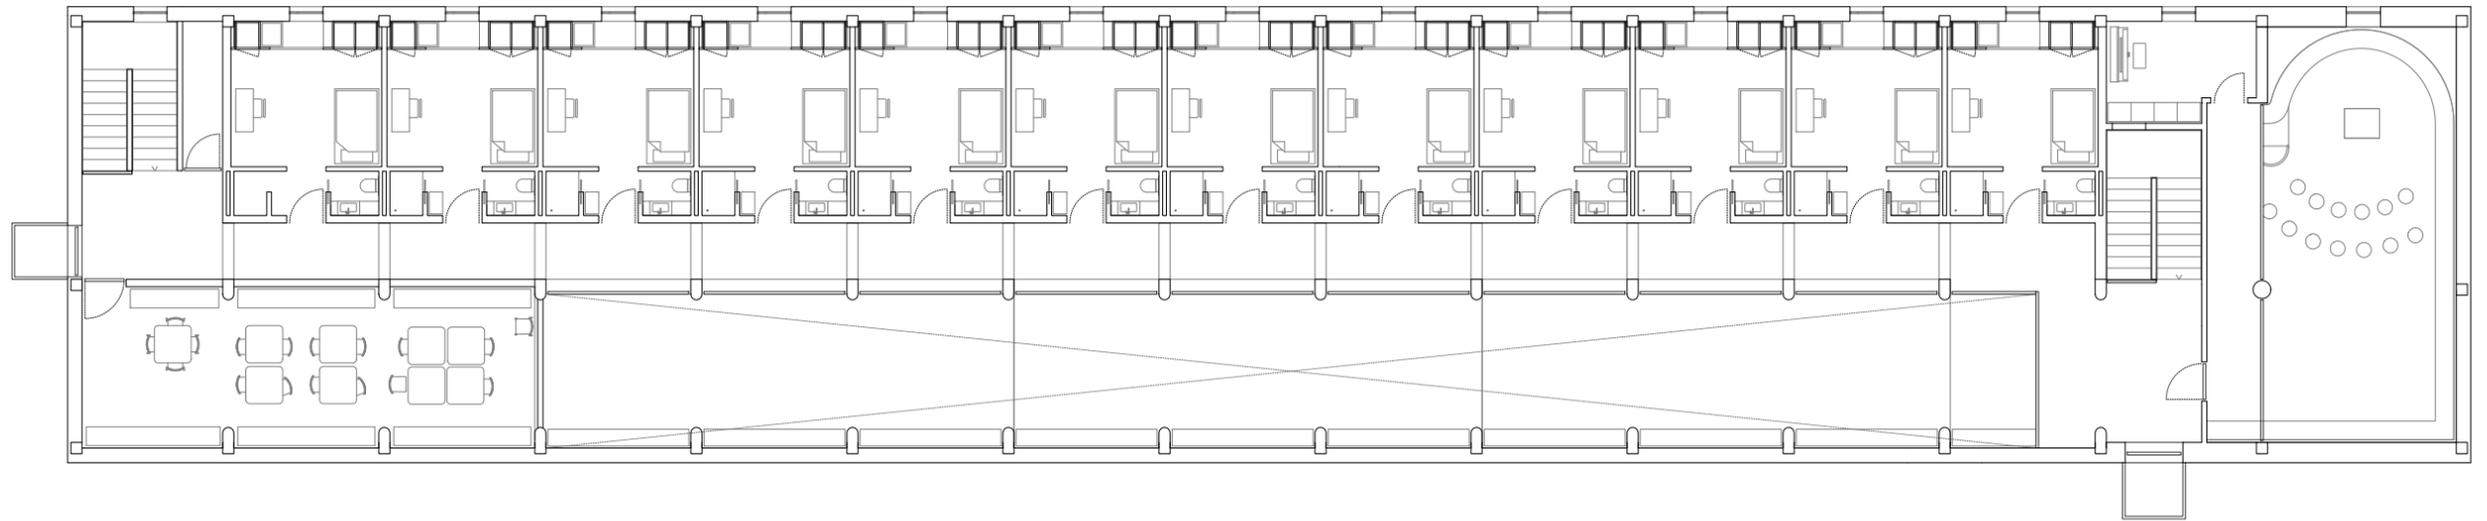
Grundriss Obergeschoss, M 1:200
